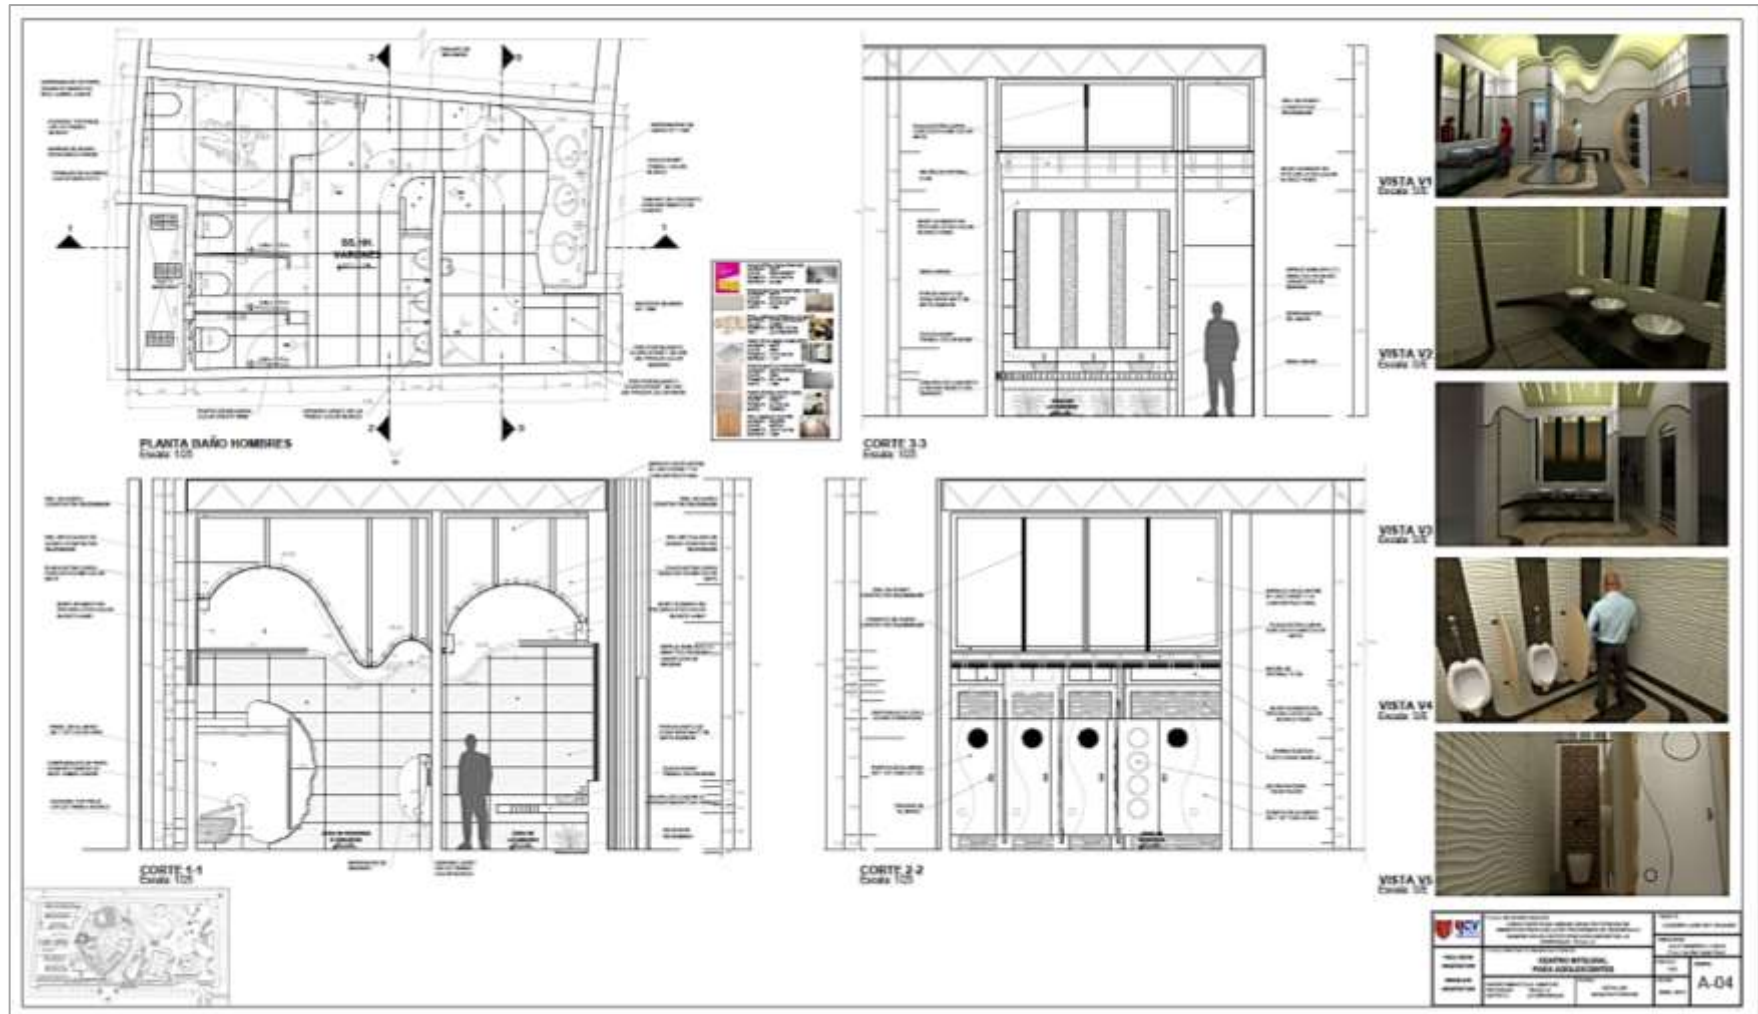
Plano de detalle arquitectónico del baño público (código: A-04)
